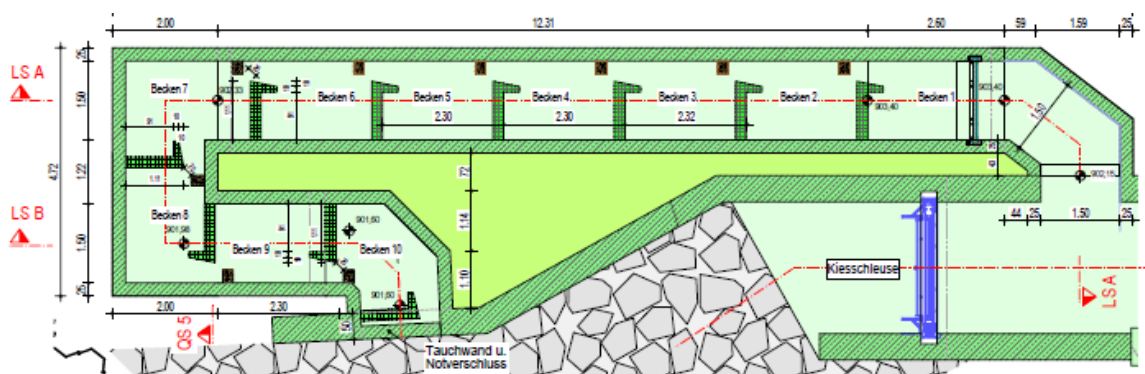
Grundriss Fischaufstiegsanlage
